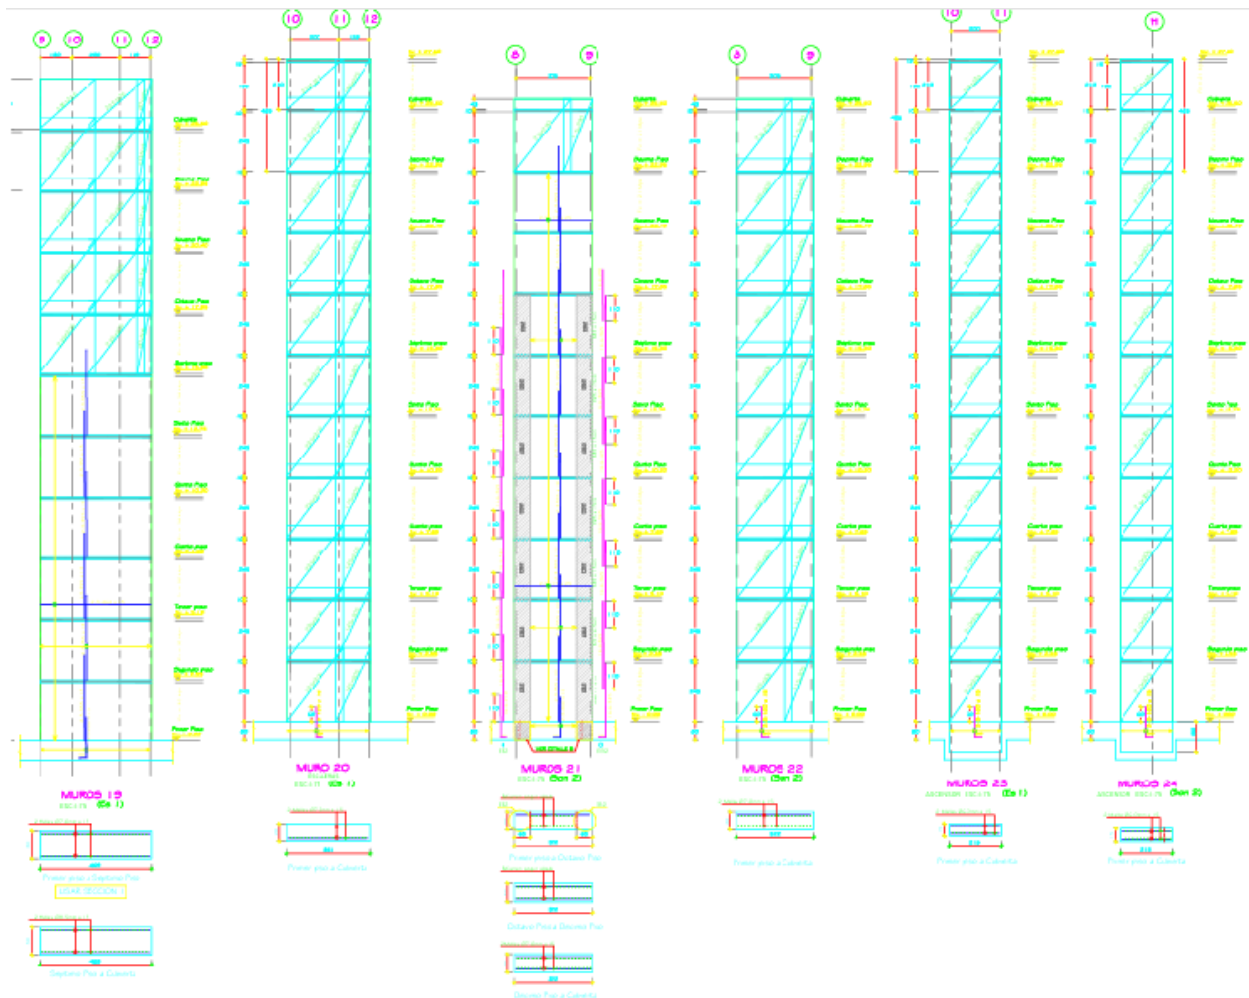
Alzadas de muros 19-20-21-22-23-24.
